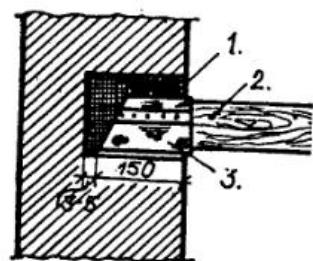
Заделывание концов балок в стены: 1 — раствор со щебнем; 2 — балка; 3 — гидроизоляция рубероидом.
